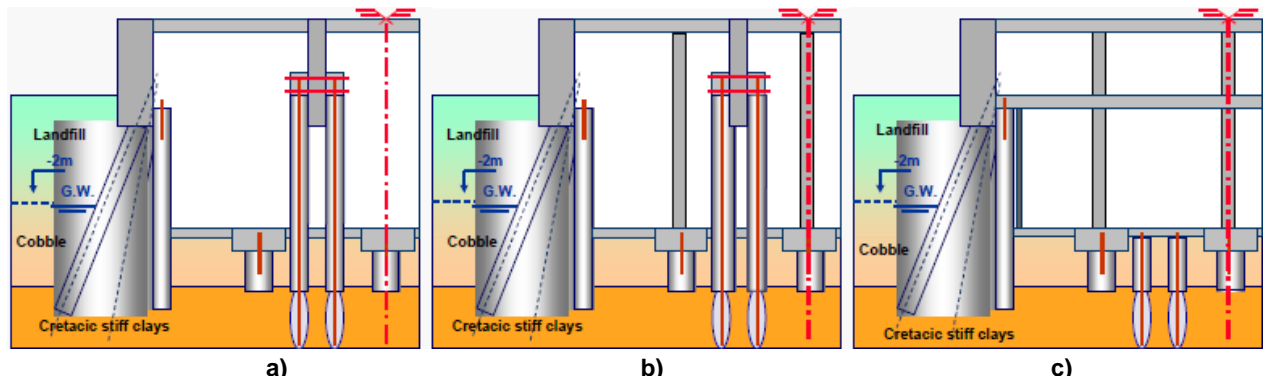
Esquema dos trabalhos nos pilares interiores: a) reforço dos pilares existentes; b) construção dos novos pilares; c) demolição dos pilares originais [64]
